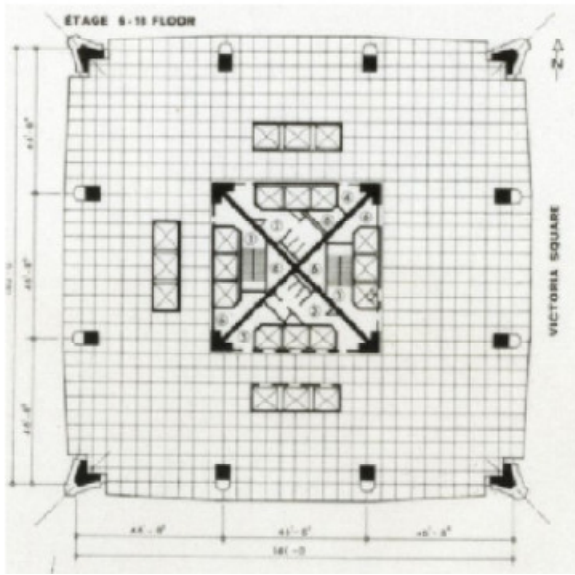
Pianta struttura Outrigger della Place Victoria Ttower, Nervi, Moretti
